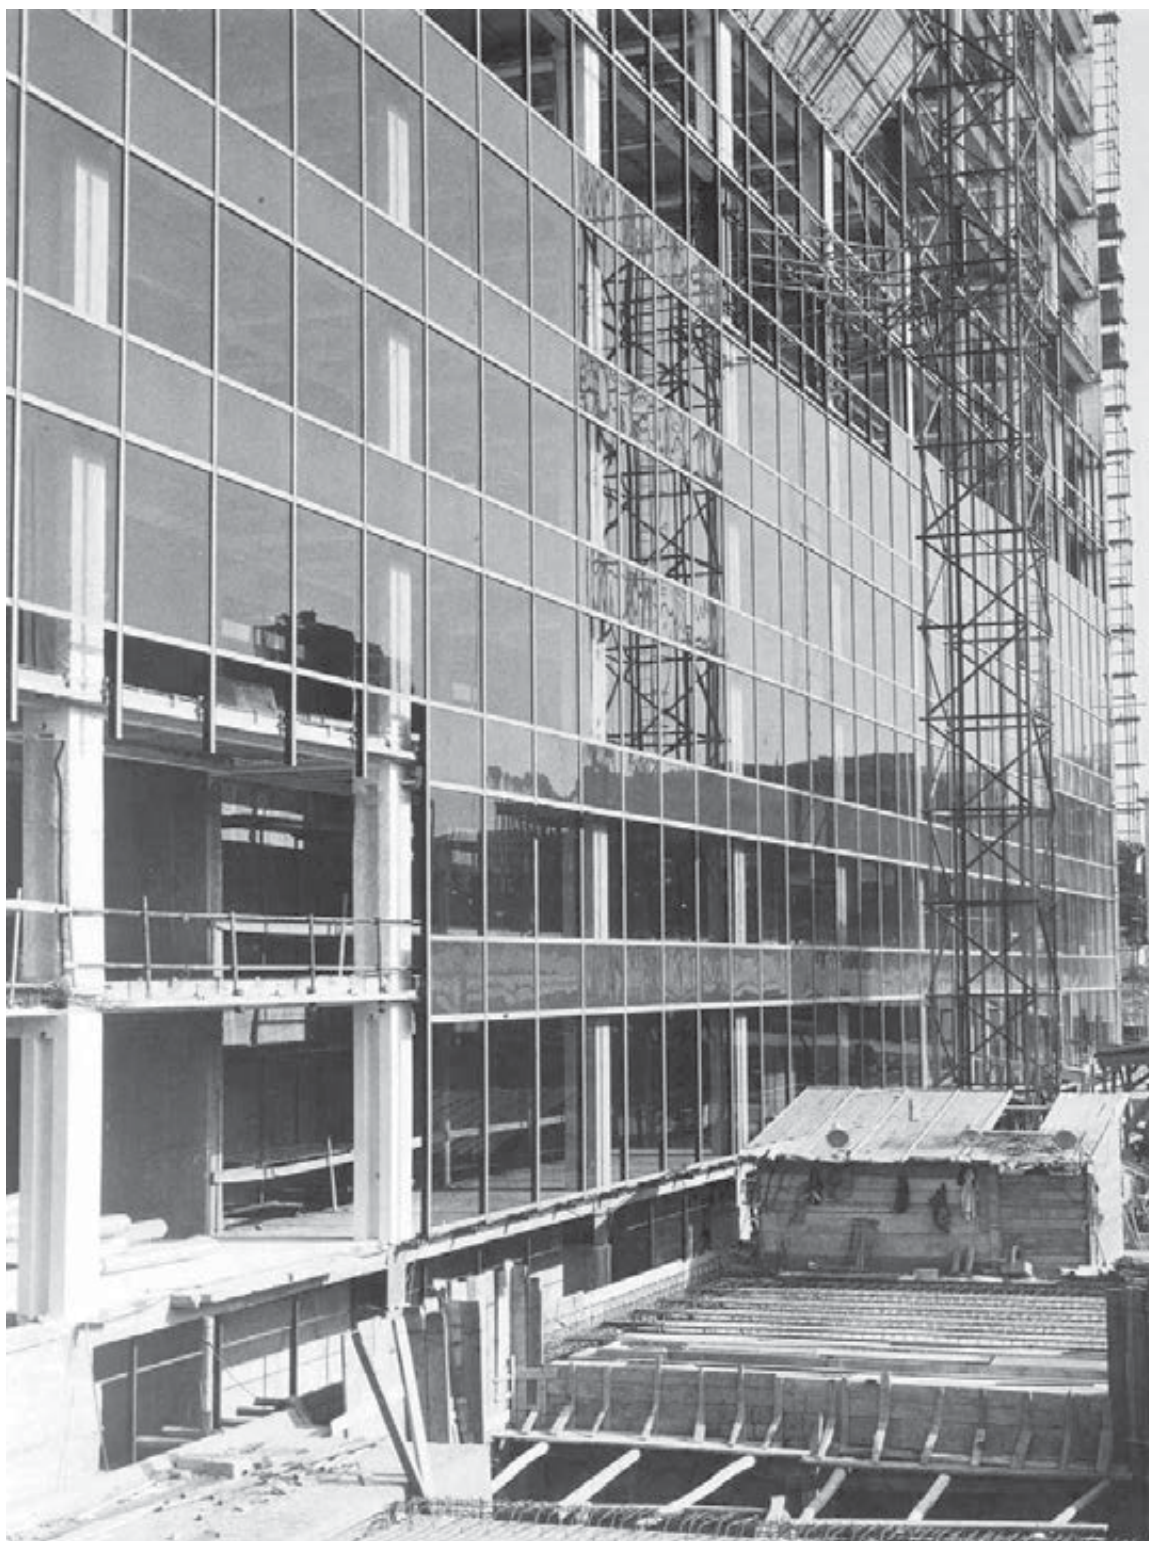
Il cantiere durante il montaggio della facciata, agosto 1961 (ASE)
